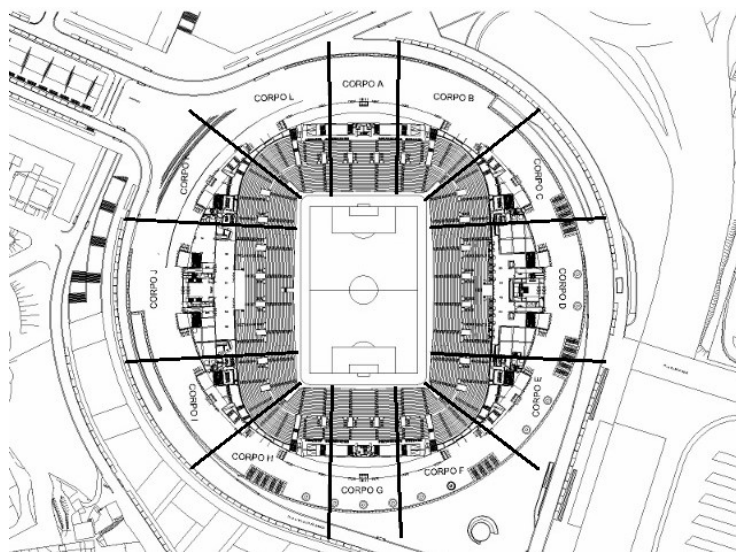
Estádio do Dragão: Planta dos corpos estruturais (GEG, 2002).
